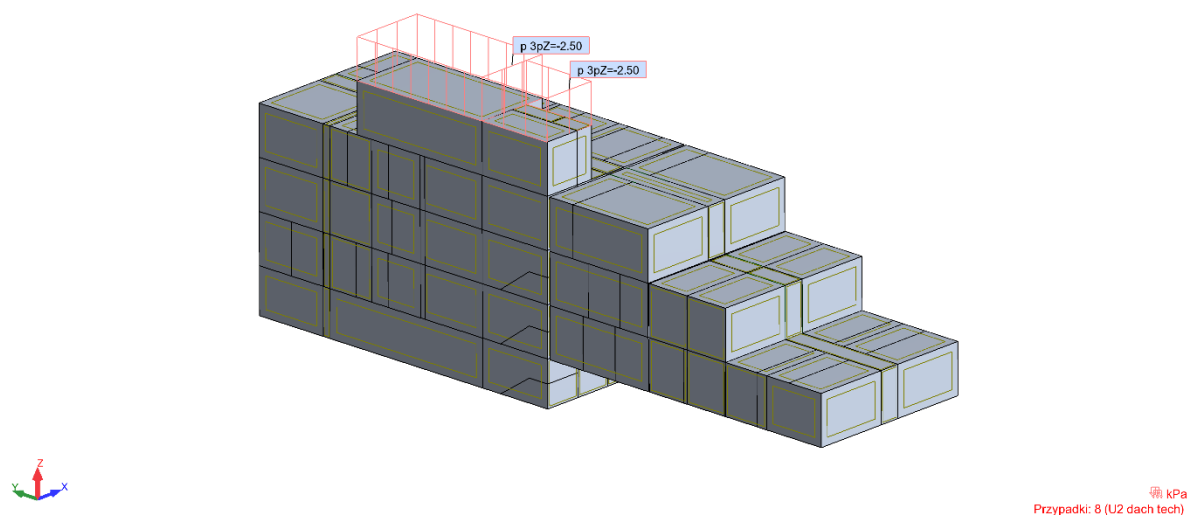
Przypadek obciążenia stałego od dachu technicznego
